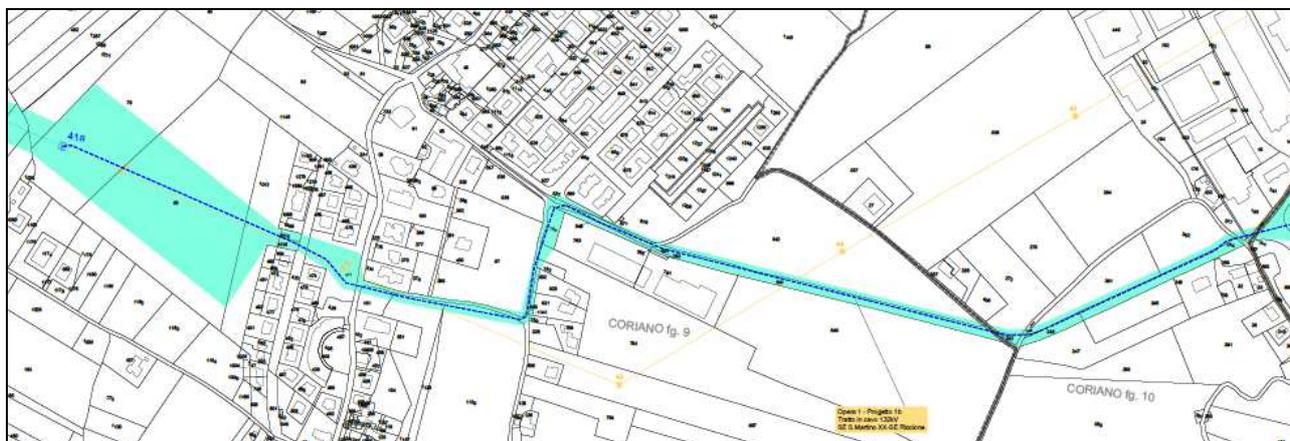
Stralcio Elaborato DGDR11008B753815 – Planimetria catastale a vincolo preordinato all'asservimento coattivo
